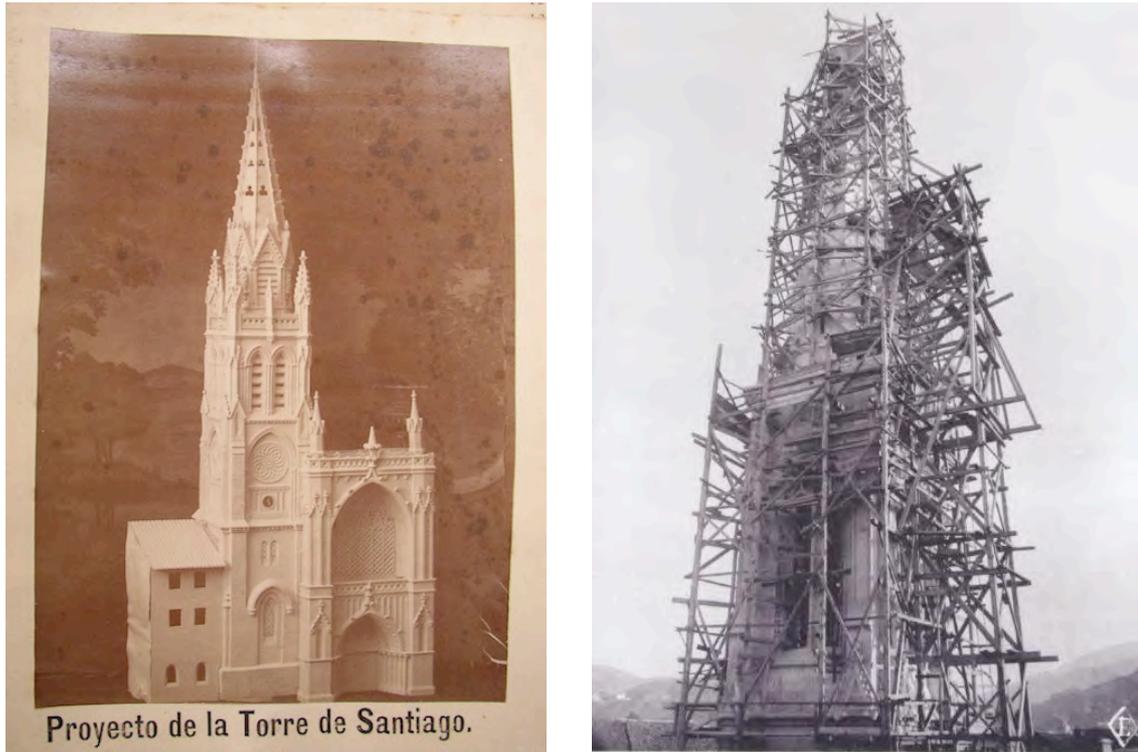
Proyecto de la torre de Santiago (c.1891), AHFB, e imagen de su construcción, "Pedro Telesforo de Errazquin. Bilbao 1860-1895".
